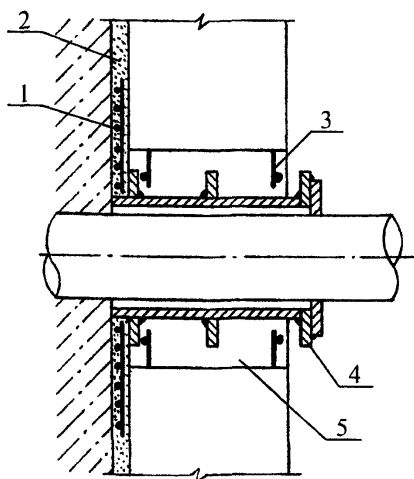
Пример решения пропуска труб через стены опускного колодца
